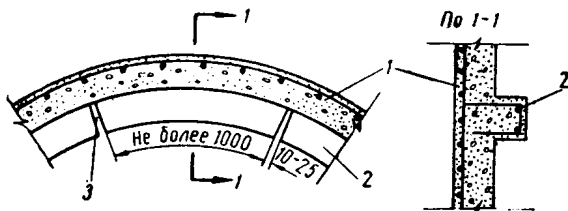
Деталь консоли в цилиндрической монолитной трубе
